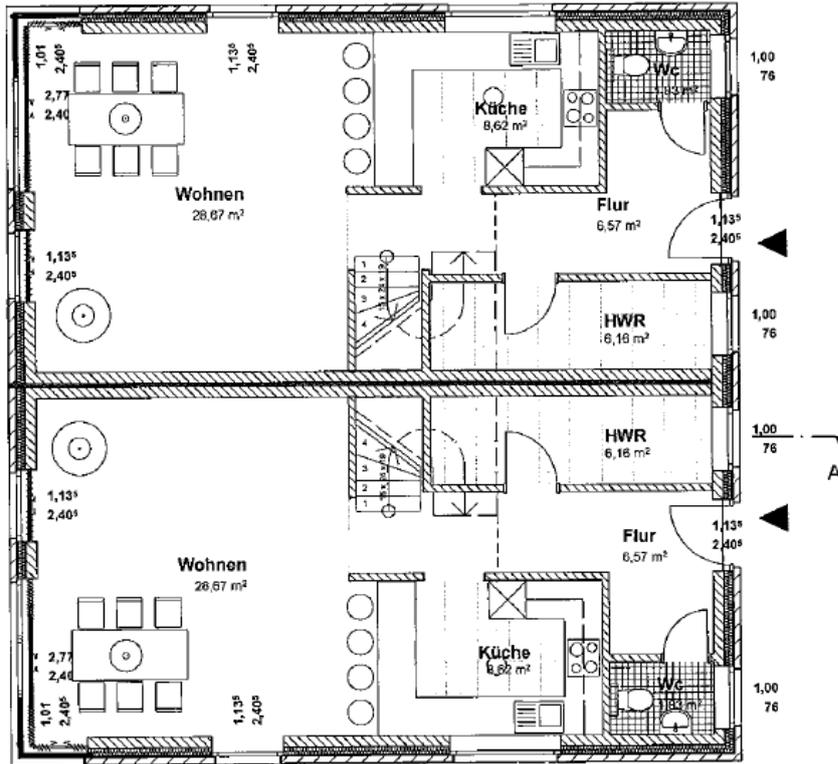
Grundriss Erdgeschoss Doppelhaus, M 1:125
